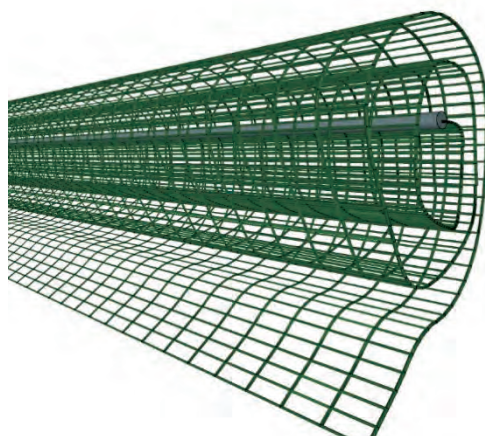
Arrotolamento della rete (preferibile)
